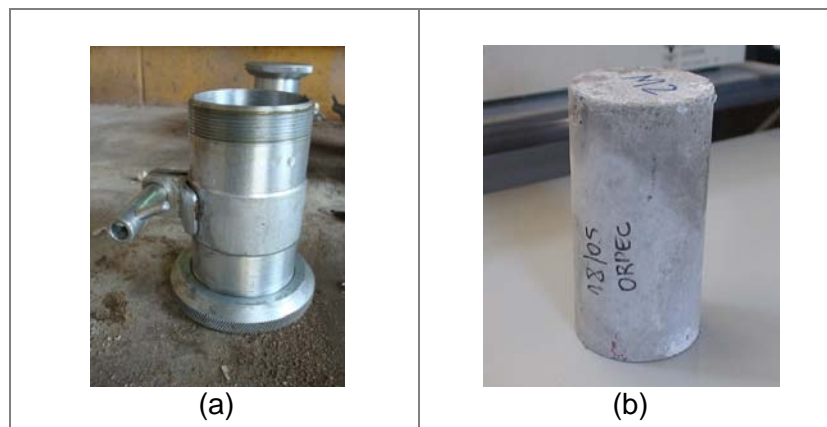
(a) Molde dos corpos-de-prova; (b) Corpo-de-prova pronto para ensaio
